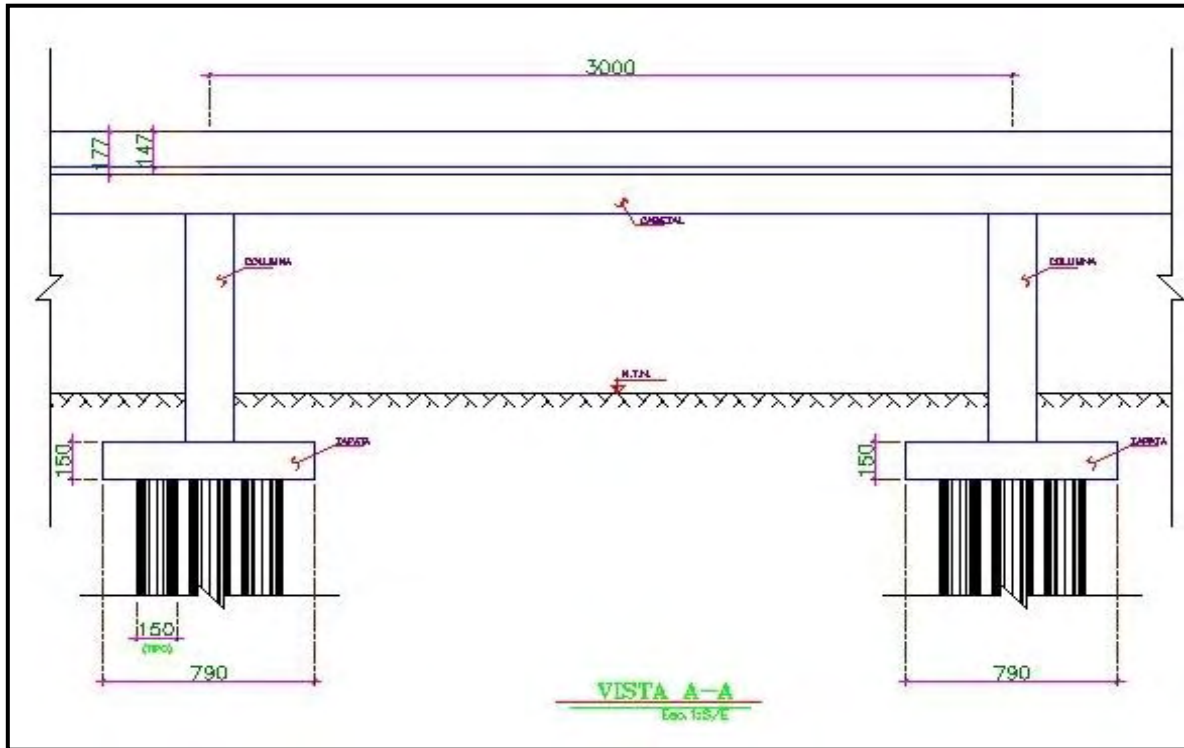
Como se muestra en las figuras 37 la vista A-A, esta es la distribución que tendrán las columnas a lo largo del viaducto, es decir una separación de 30.00m entre el centro de cada columna, esto es debido a que las piezas serán prefabricadas y se tiene una medida estándar en las plantas de armado. Así mismo se observan las medidas de las zapatas sobre las cuales se desplantan las columnas que sostendrán las traveses prefabricadas.
